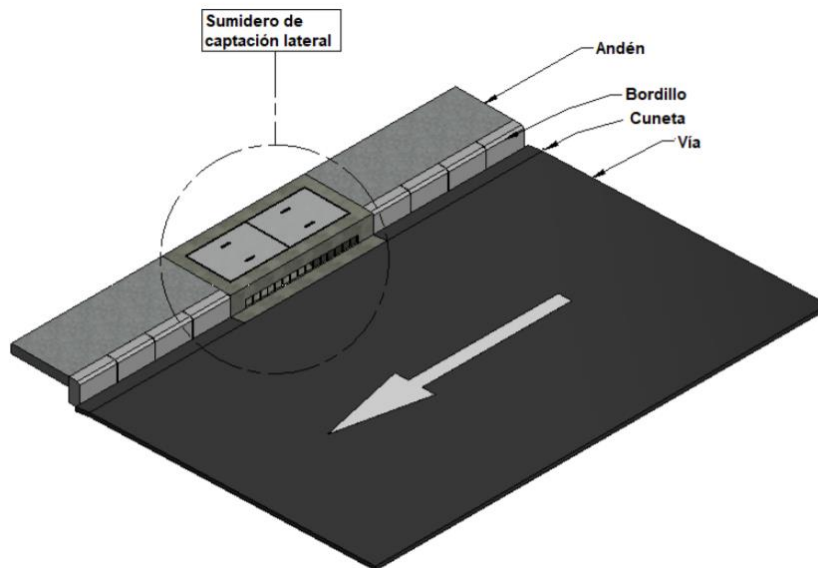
Vista en planta y ubicación de sumidero de abertura. Fuente: Norma colombiana de construcción
